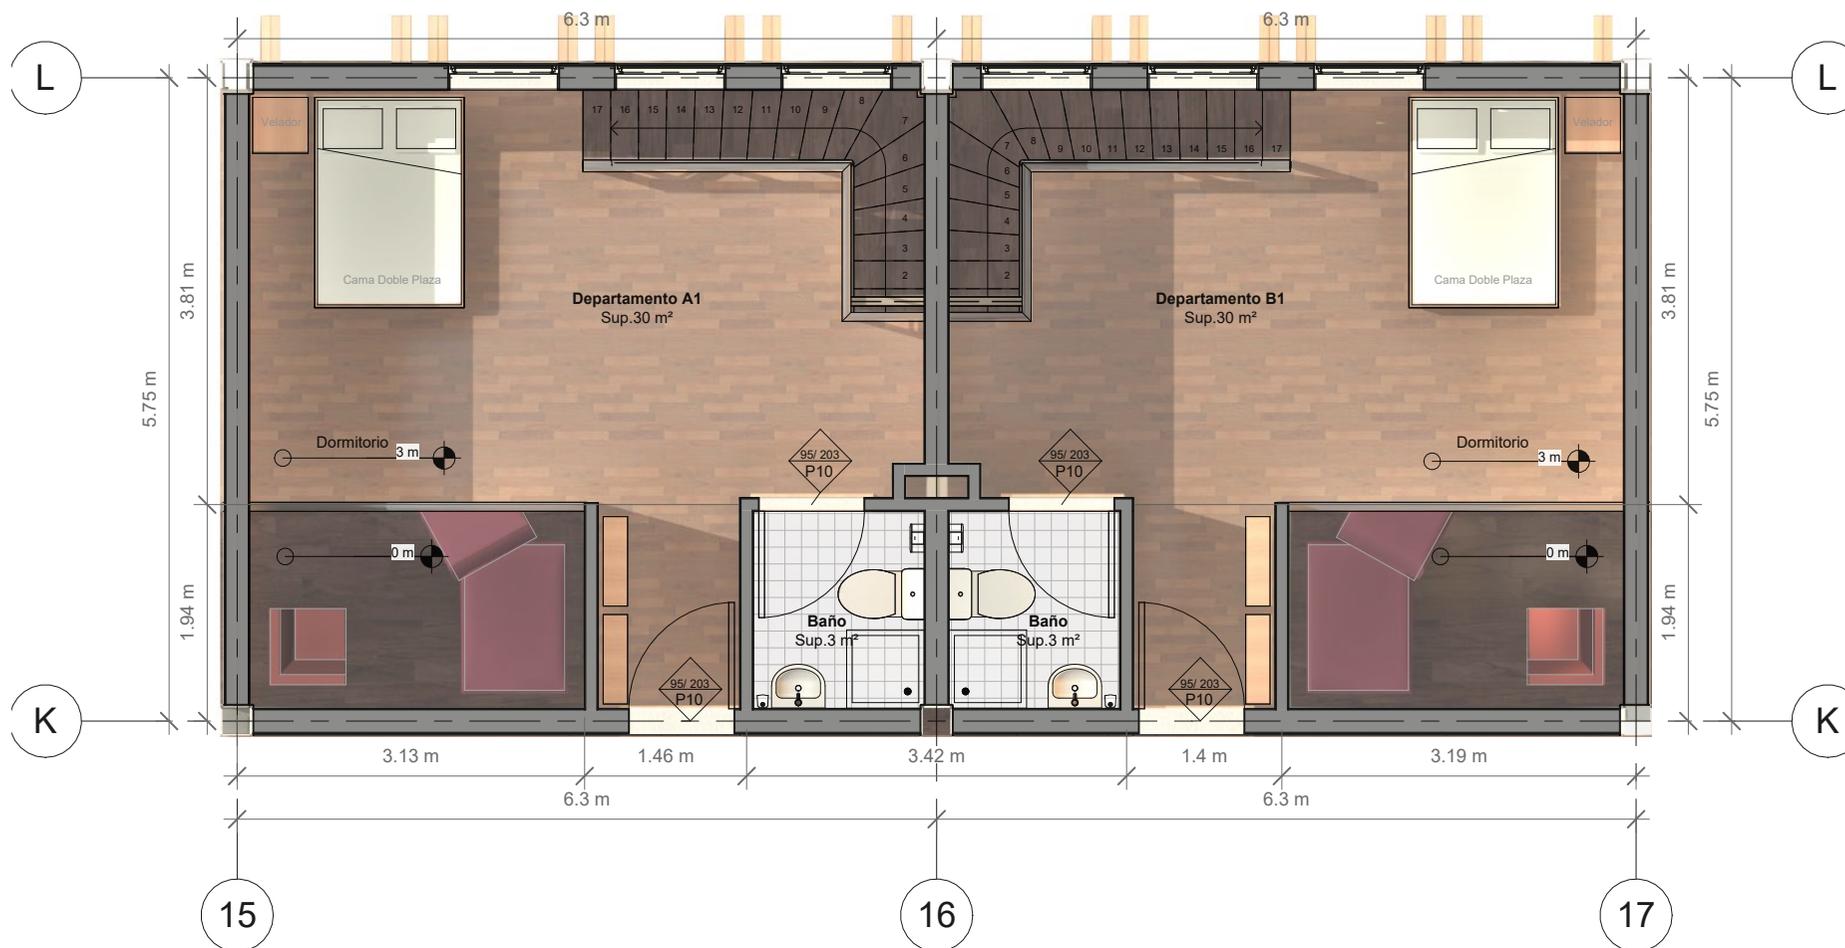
/8: Render Tipología A1/B1 propuesta.
